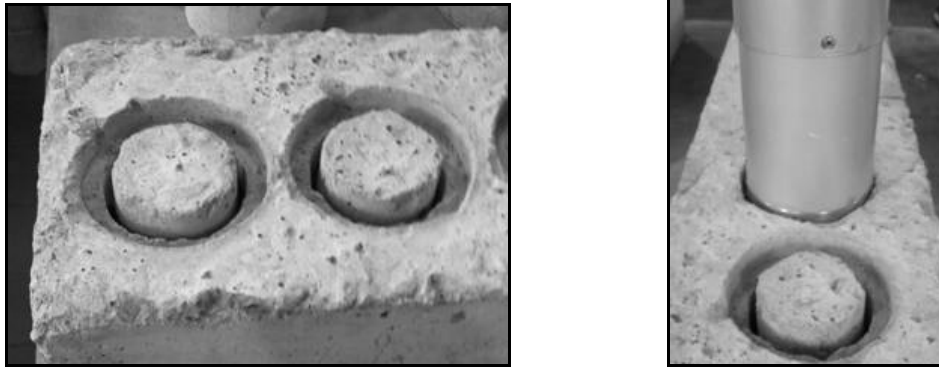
Testigo calado y base para apoyo de la celda de carga del ensayo Break-Off.
